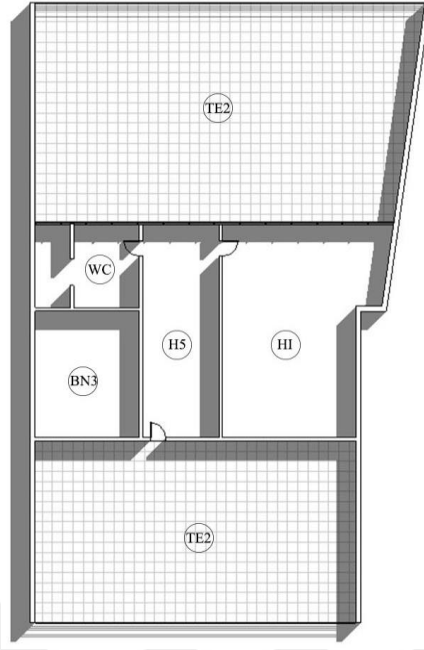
Şemsettin Sirer Yalısı giriş kat planı
